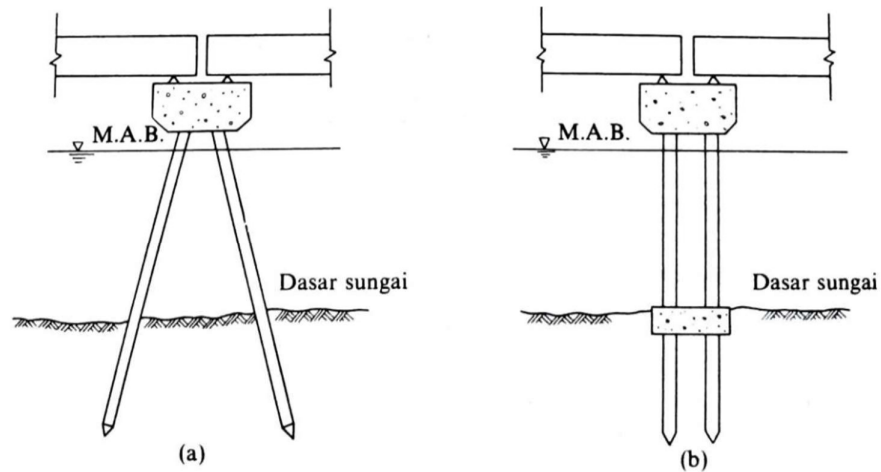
Bentuk umum pilar jembatan yang dibangun di sungai
